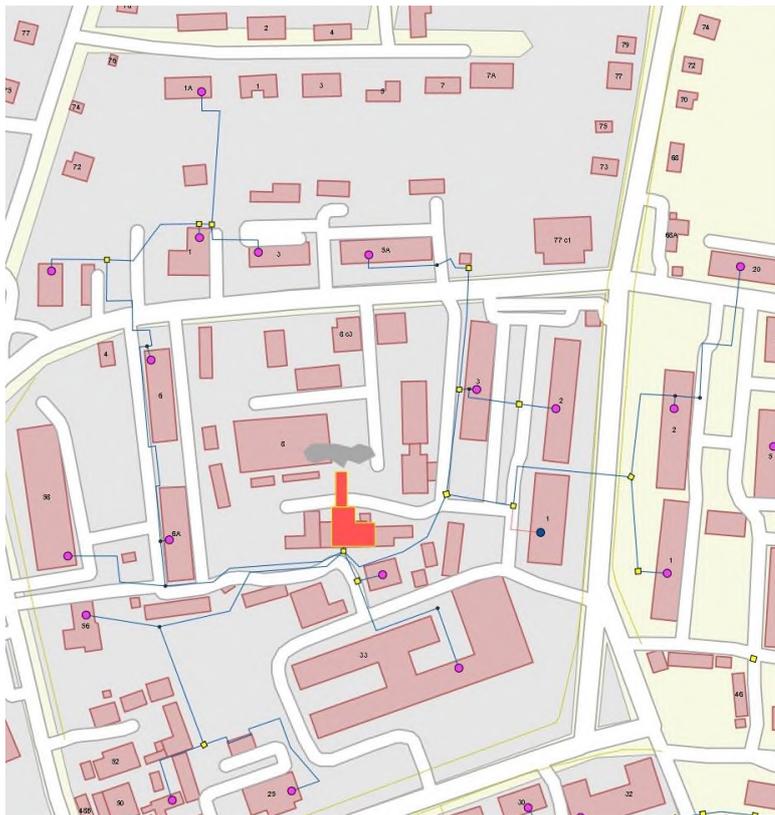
Схема теплоснабжения от котельной № 1/2
